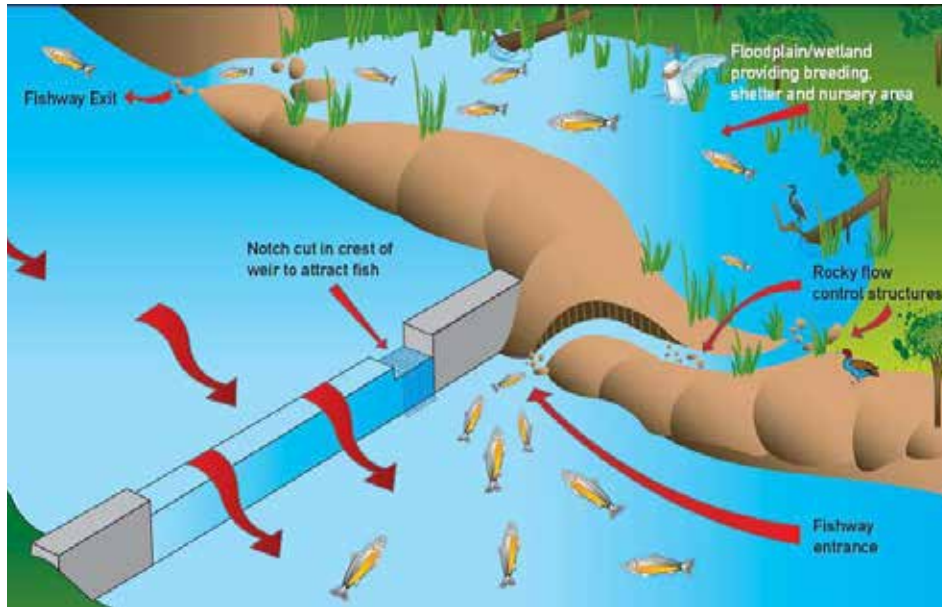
Pasaj bypass din Reconnecting off-channel habitats to waterways – using engineering techniques to restore fish passage. Department of Water, Government of Australia
